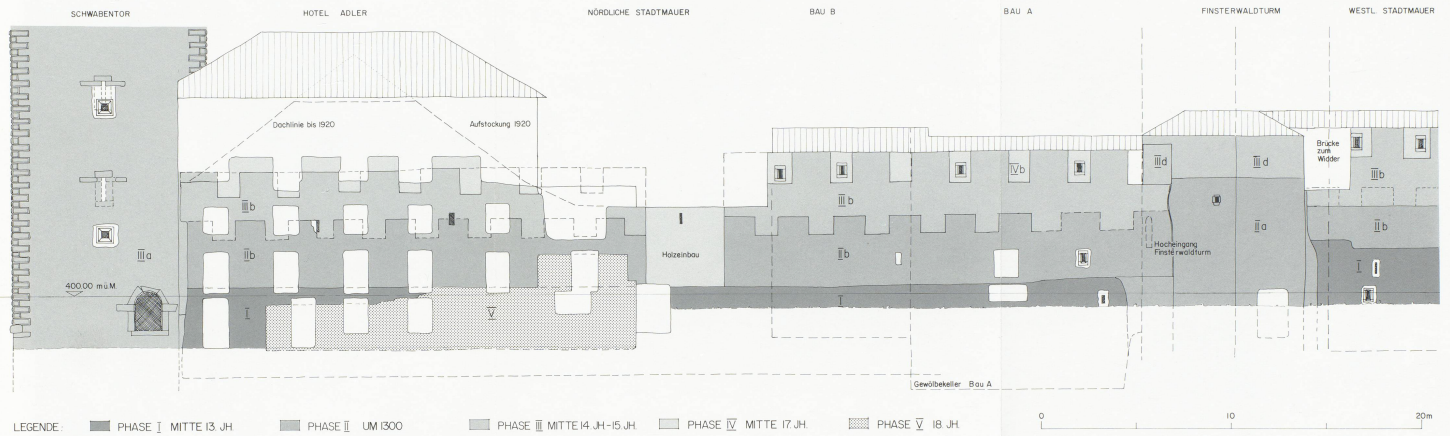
Fassadenabwicklung der nordwestlichen Ecke der Stadtbefestigung mit Schwabentor und Finsterwaldturm. M. 1:200.
